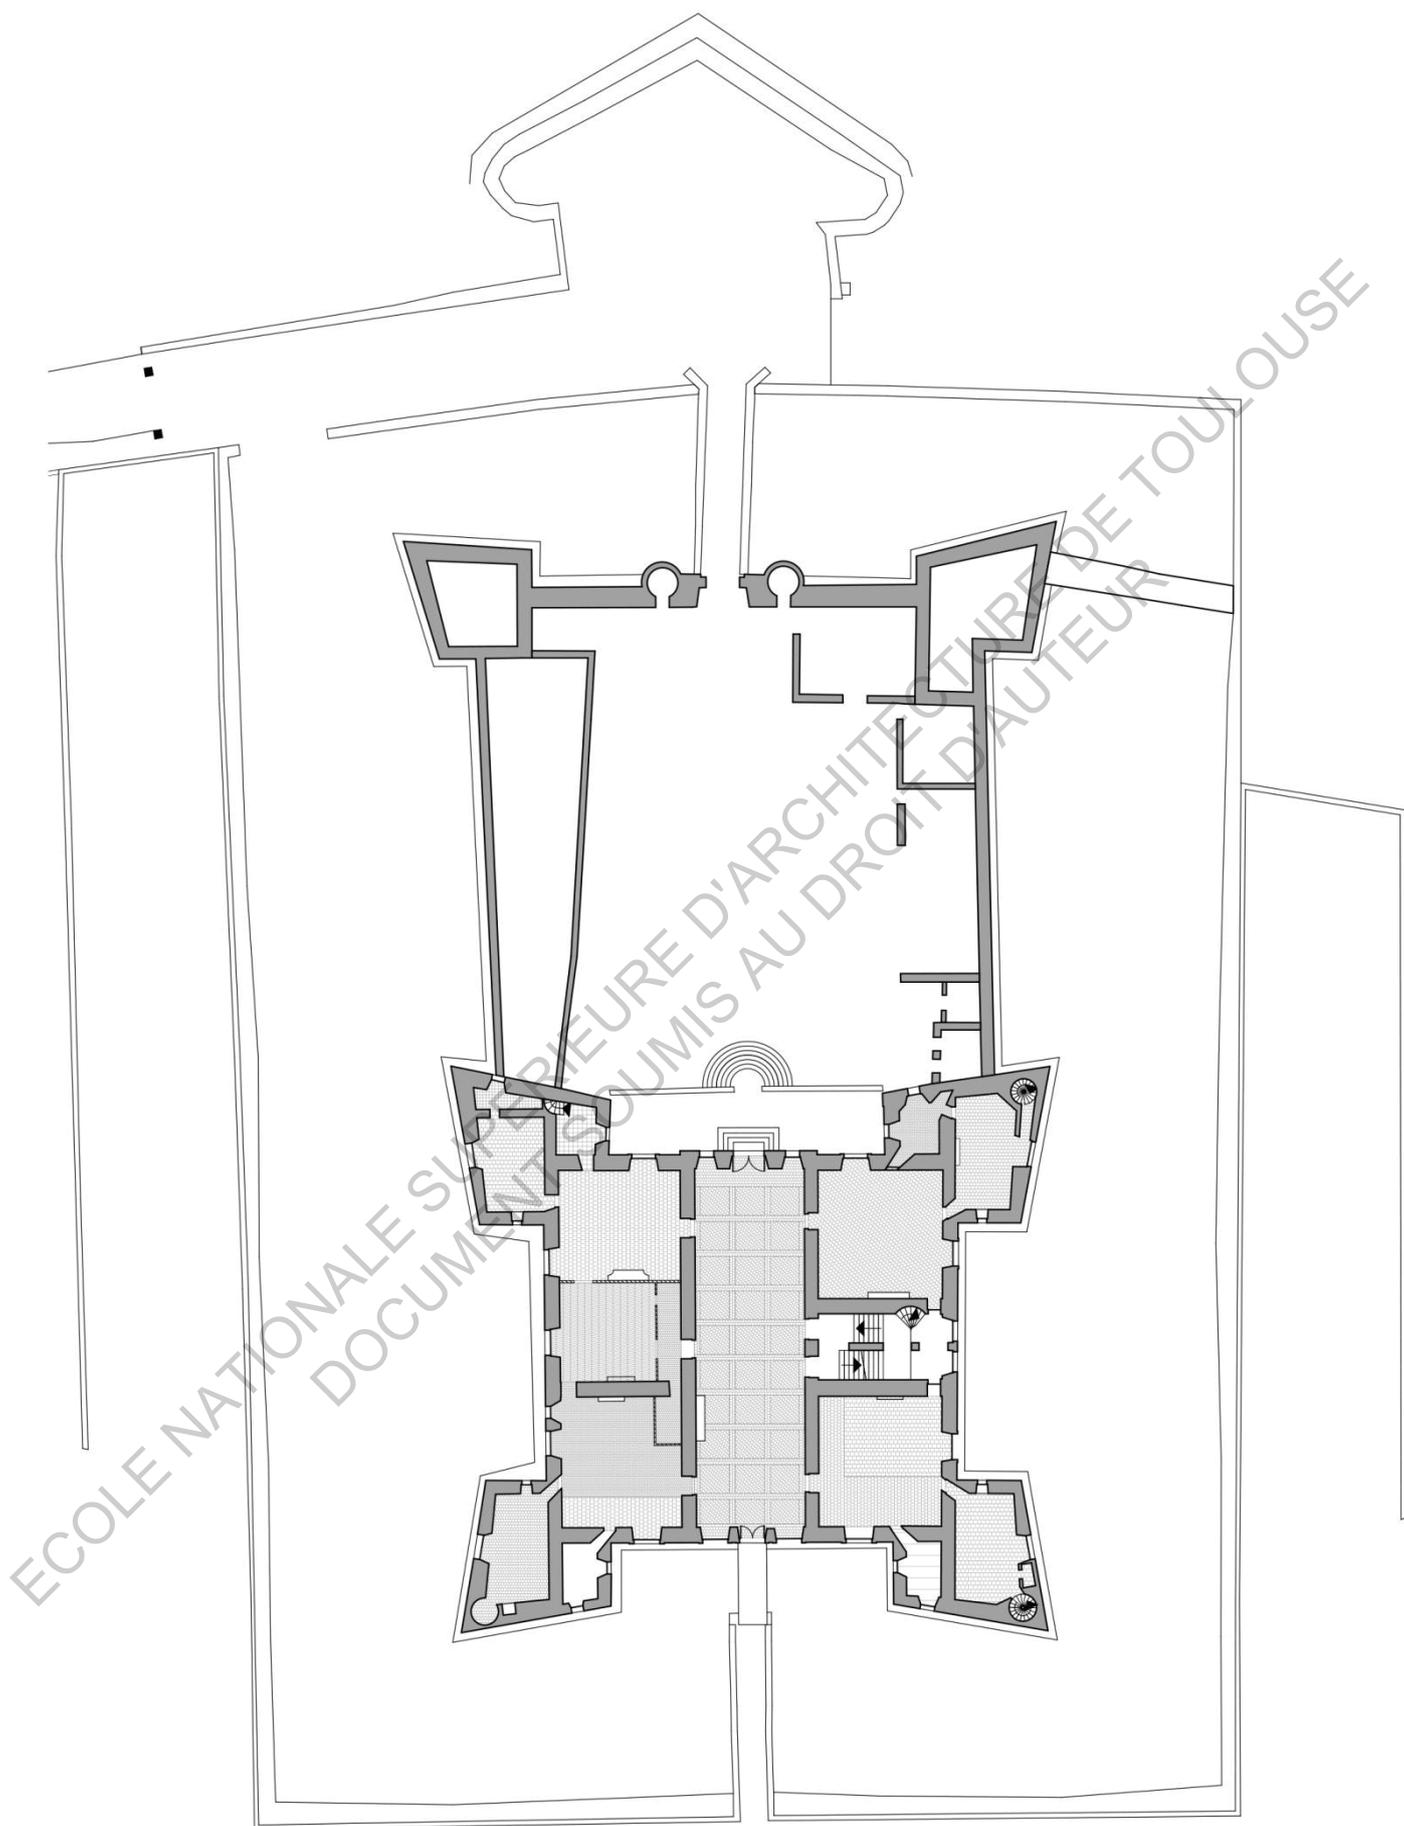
Plan du rez-de-chaussée, entouré de ses fortifications. Echelle 1/500<sup>e</sup>.
